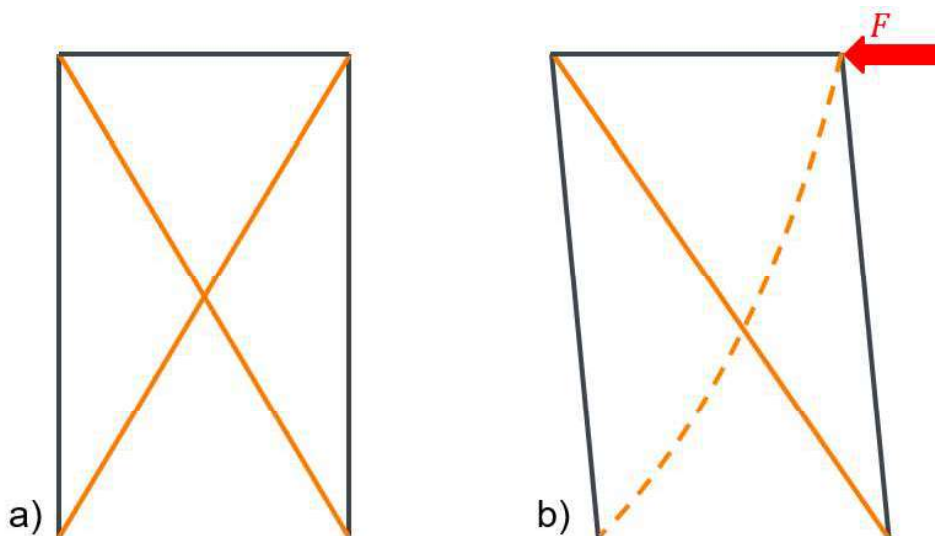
2D Beispiel eines Tragwerks mit druckschlaffen Elementen.
